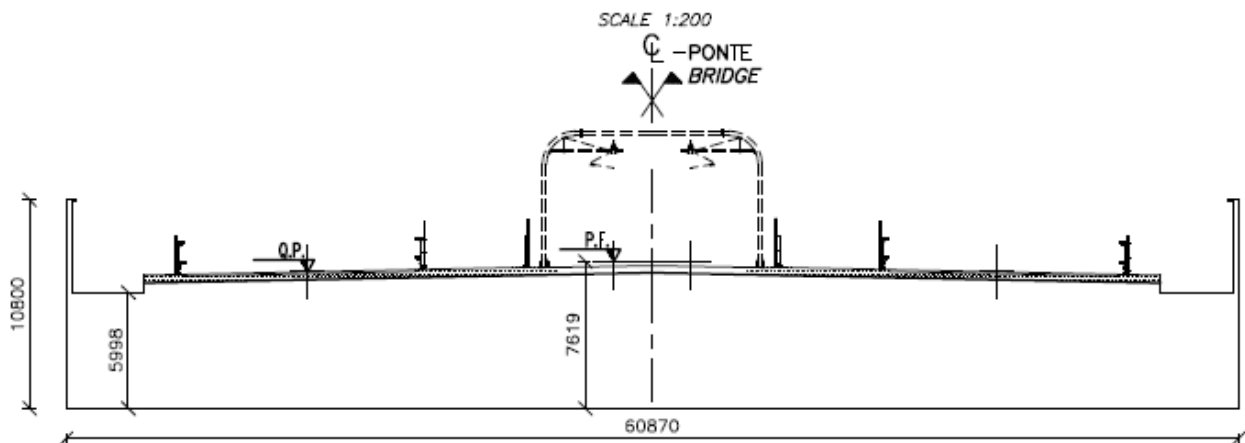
Sezione trasversale dell'impalcato in calcestruzzo
